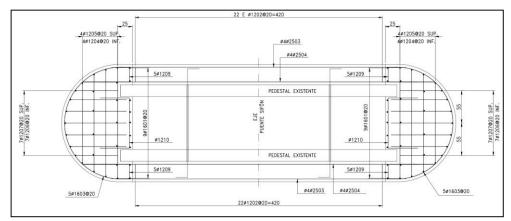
Planta extensión de mesa de apoyo y topes sísmicos laterales
